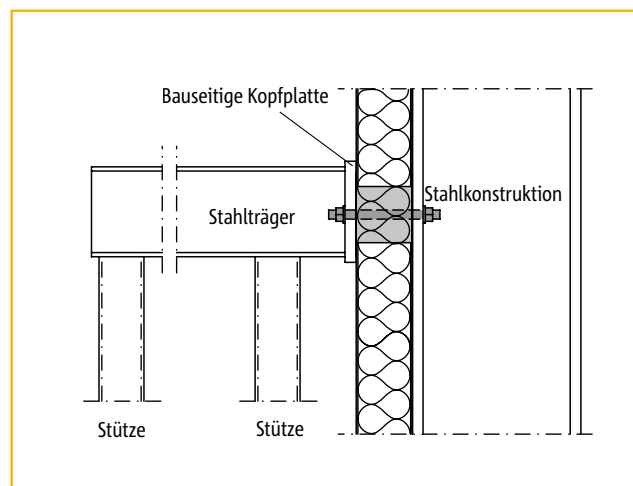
Schöck Isokorb® Typ KST-ZST Modul für vorgeständerte Stahlkonstruktionen
